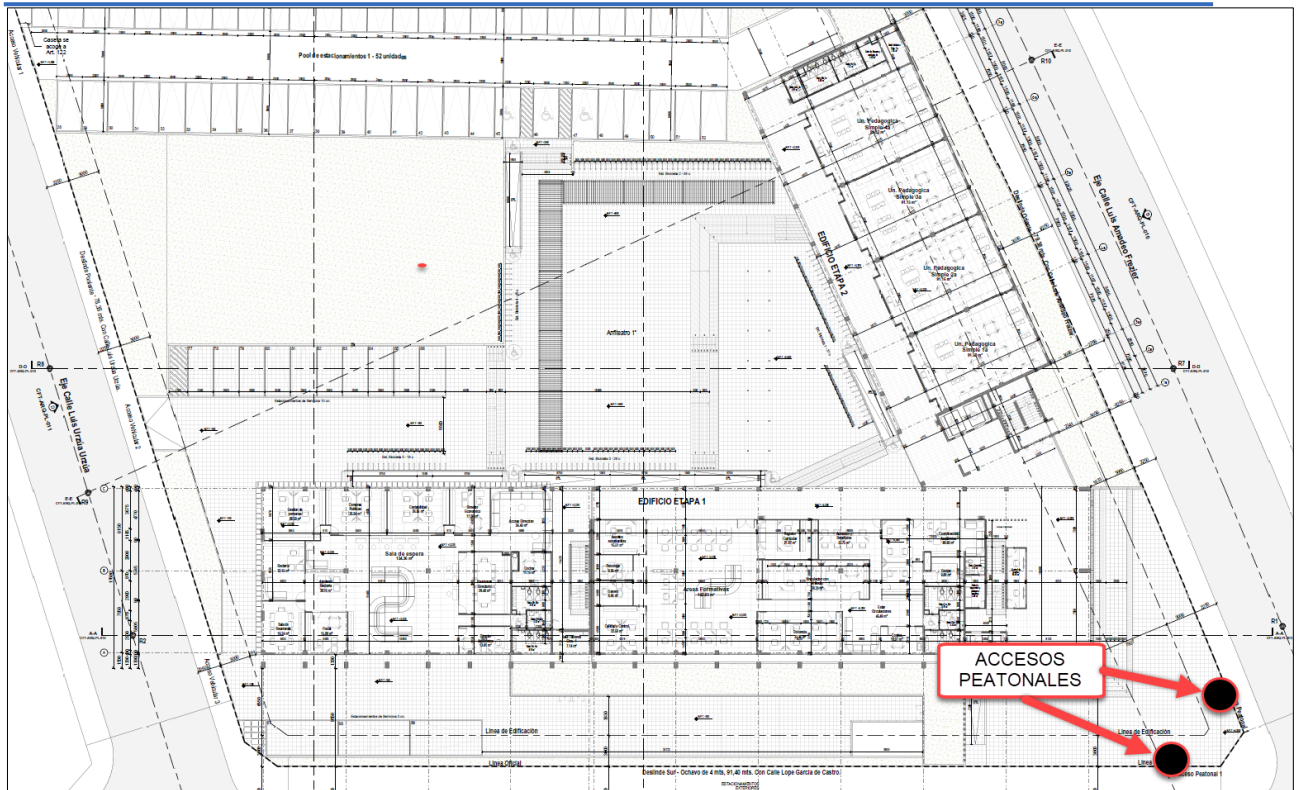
Accesos peatonales proyectados – Planta primer piso
